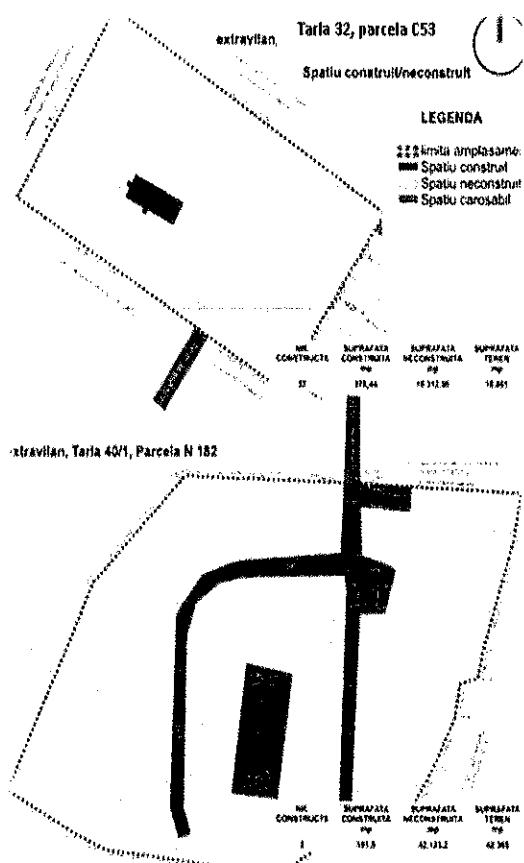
Tarla 32, parcela C53, nr. cadastral 247, Tarla 40/1, parcela N182, nr. cadastral 248, Spațiu construit – neconstruit
